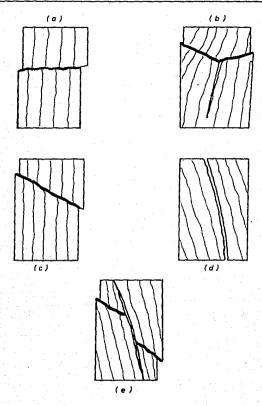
Fig. VI.l Tipos de fallas en la madera bajo compresión a la fibra.
